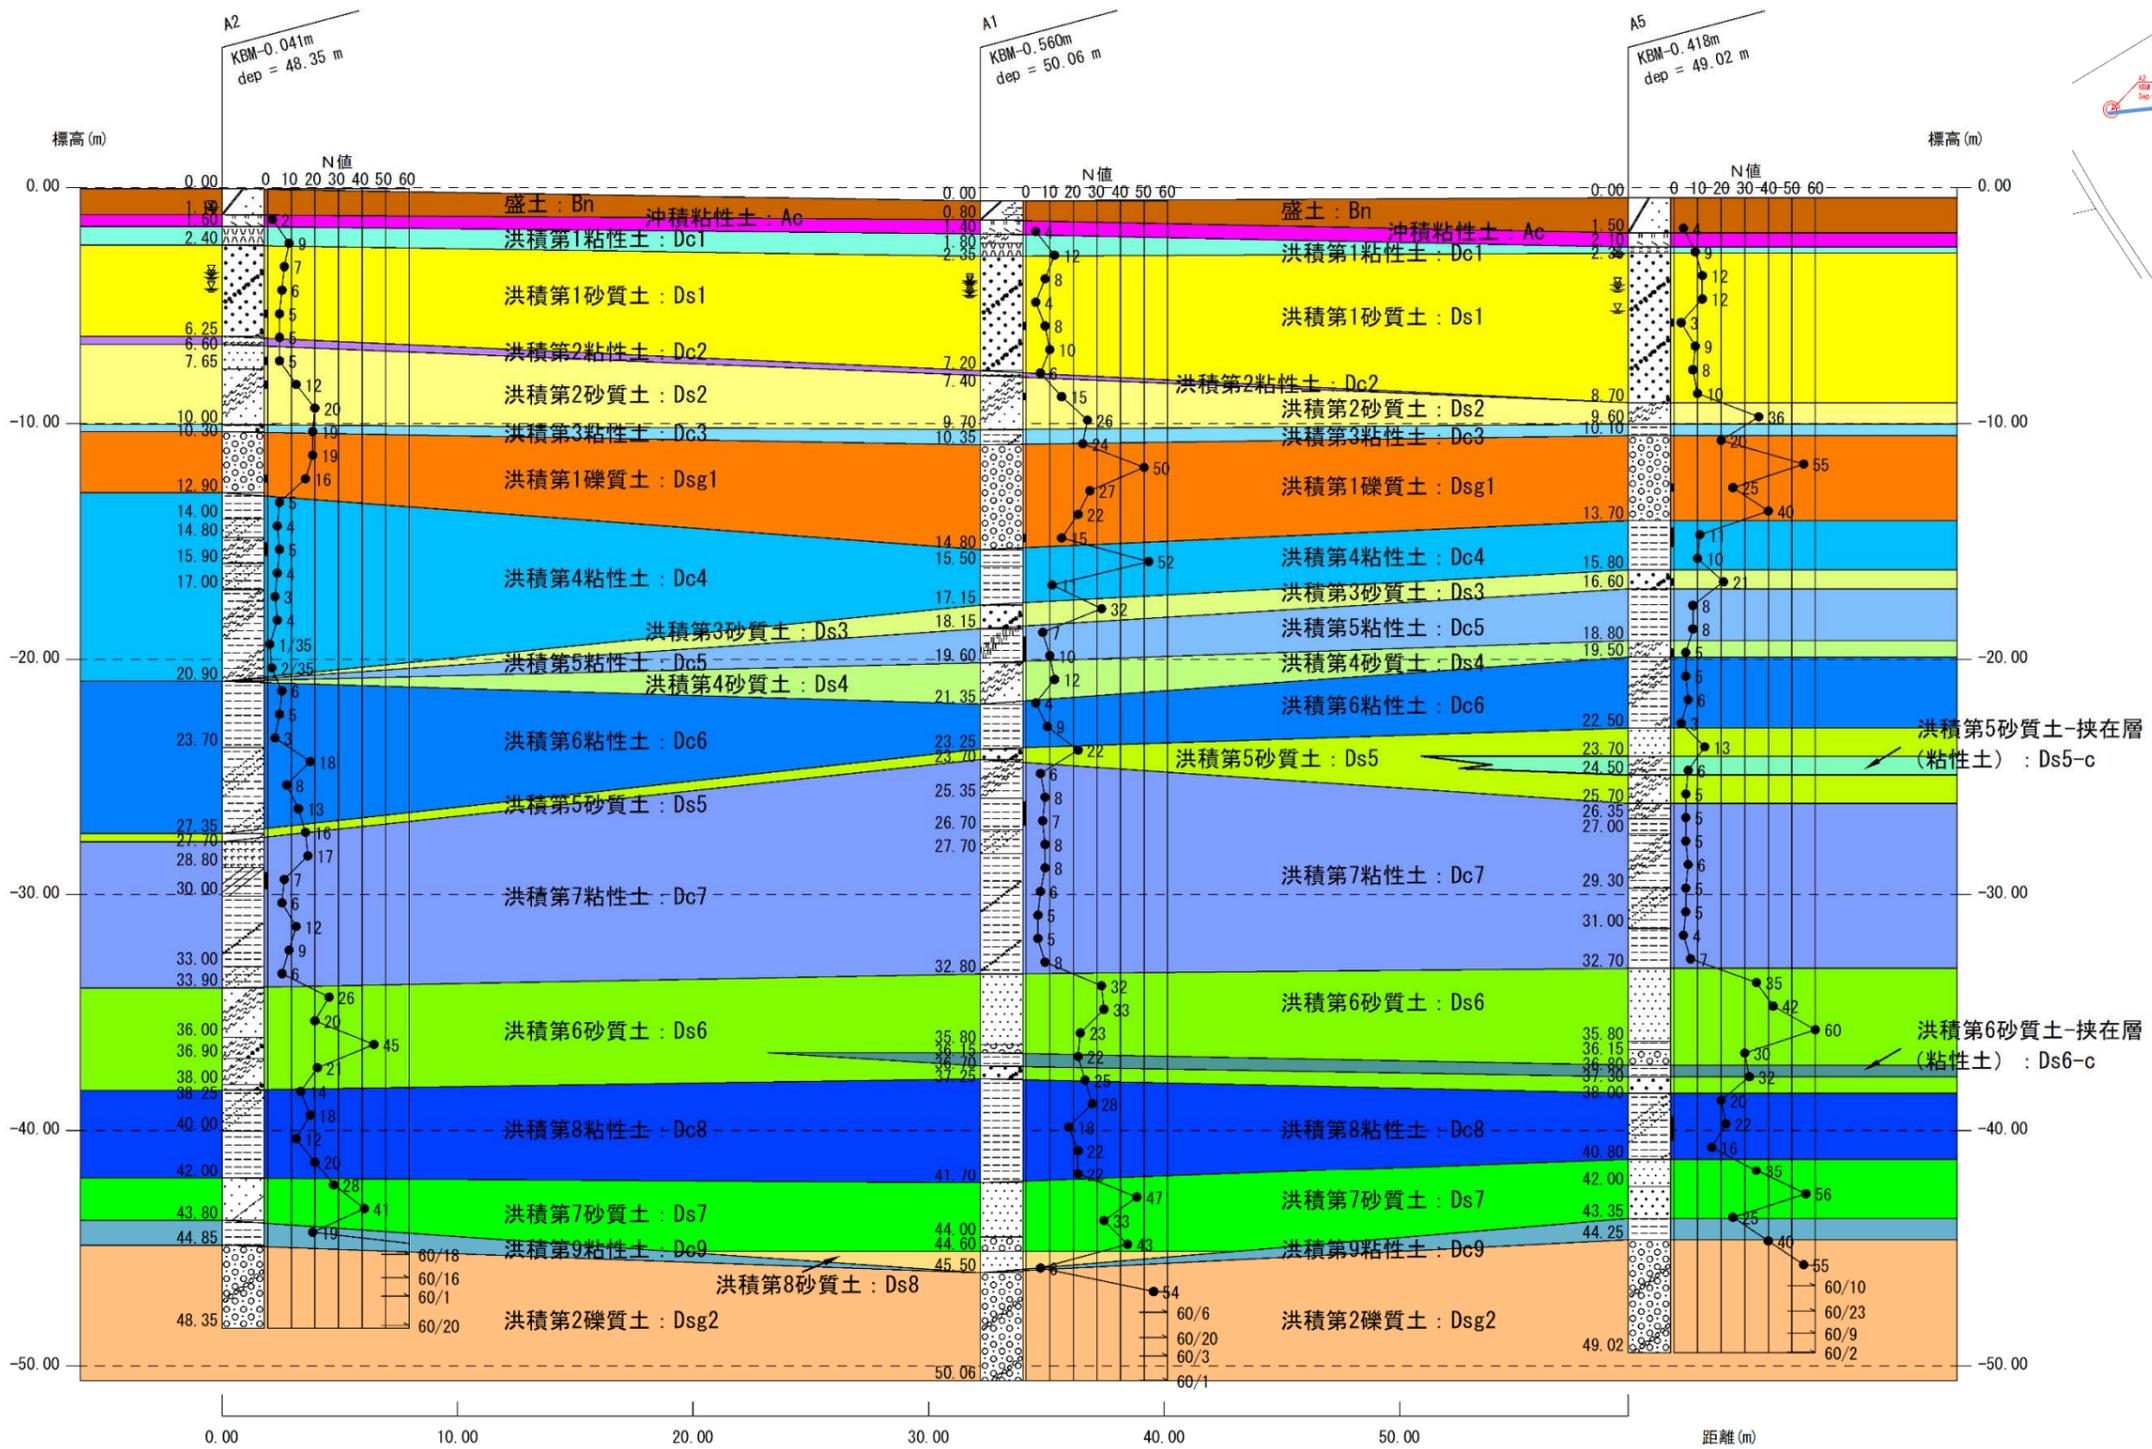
推定地層断面图 A2-A1-A5 (S=1/300)
